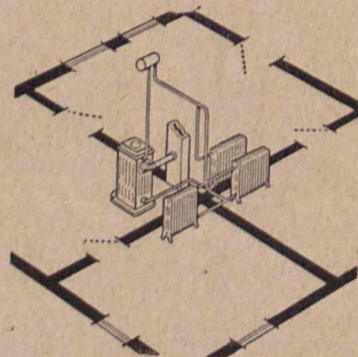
Grundrißschnitt der Anlage einer Warmwasserzentralheizung für vier heizbare Räume.
